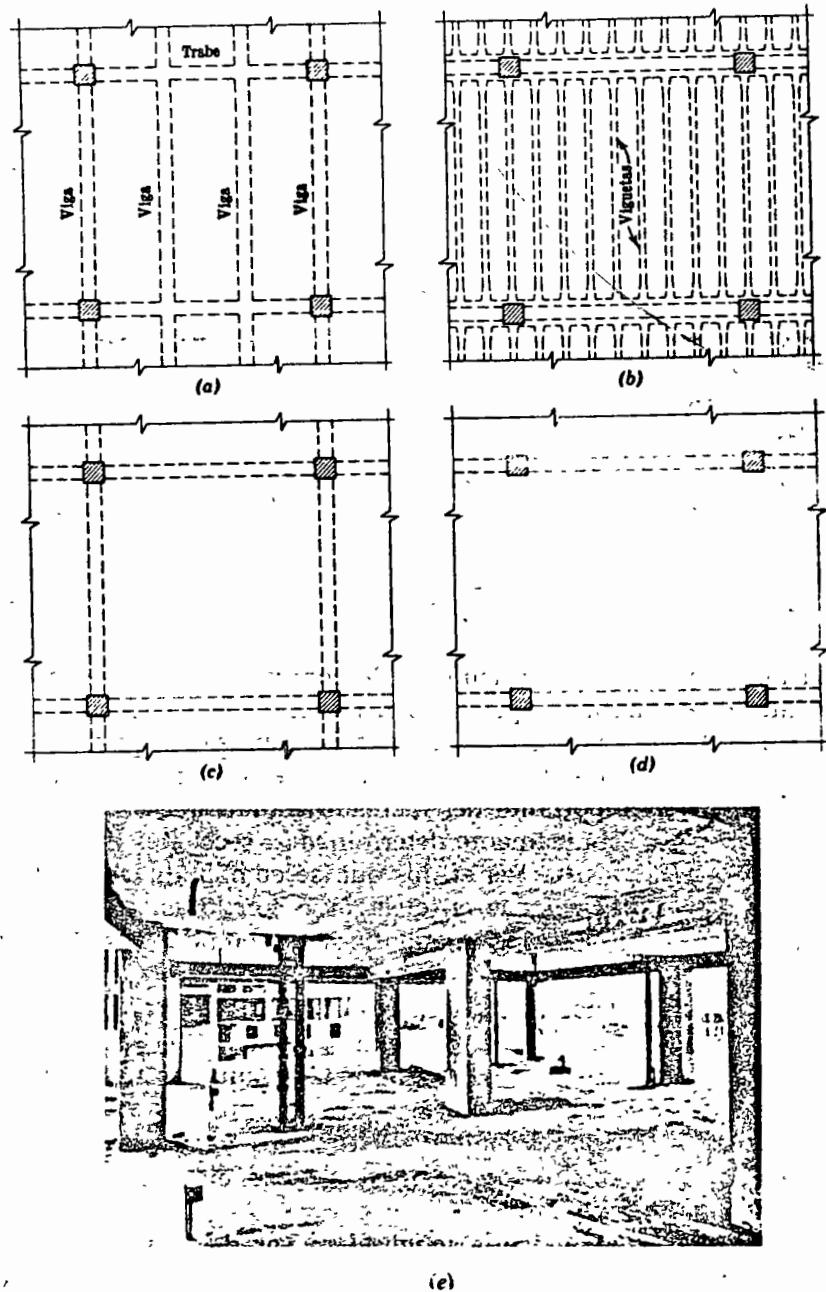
Entramado típico de vigas de los pisos. (a) Sistema de vigas y trabes. (b) Construcción de viguetas. (c) Vigas con losas reforzadas en dos direcciones. (d) Vigas con losas reforzadas en una dirección apoyadas en vigas transversal. (e) Construcción en una dirección. (Cortesía de la Portland Cement Assn.)
